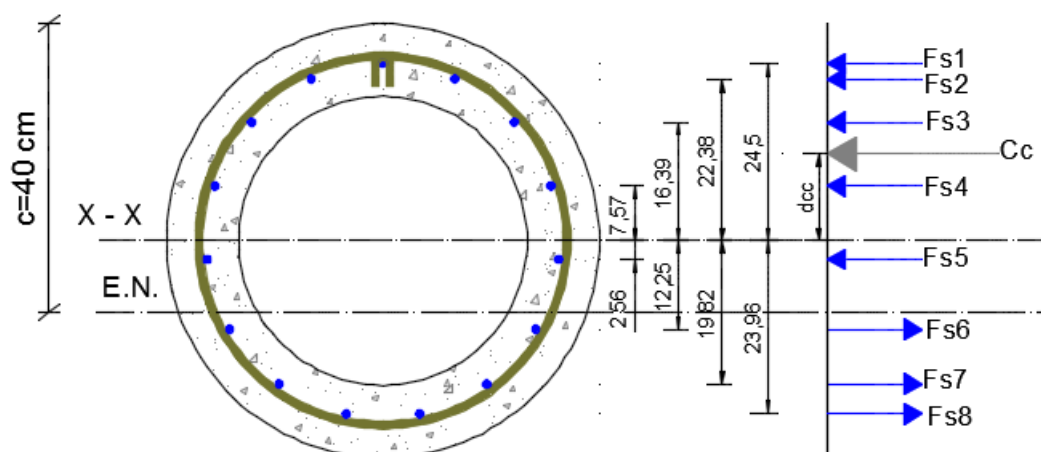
Esquema general de deformaciones, esfuerzos y fuerzas en la sección transversal circular
